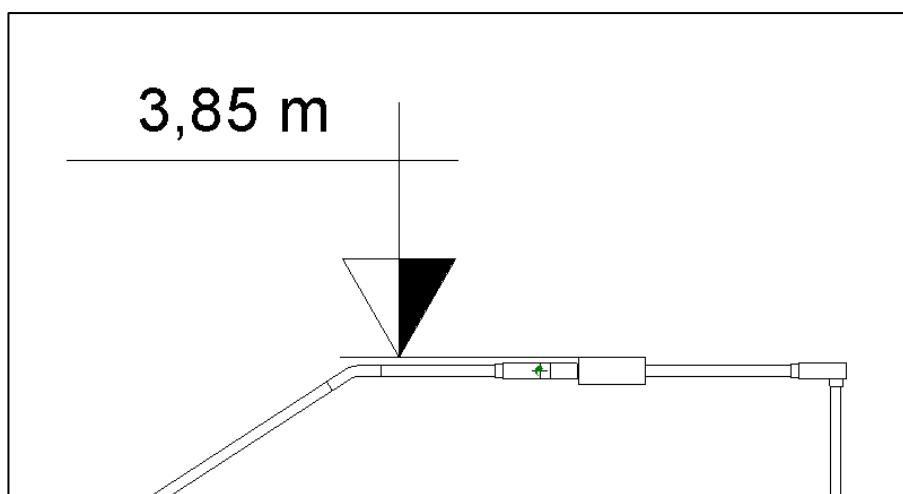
SPOT ELEVATION PARA ANOTAR ELEVAÇÃO DE ELEMENTOS.
